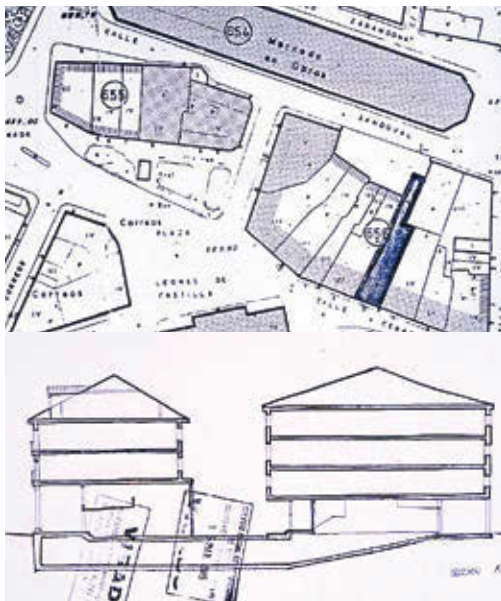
/ Proyecto de edificio situado en la calle Cebadería.
